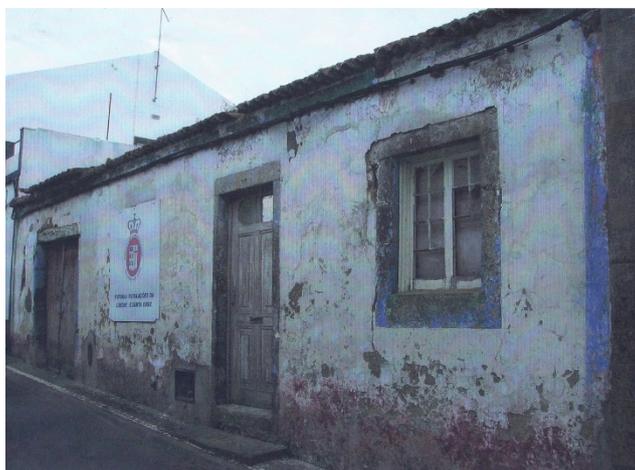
Edifício degradado, adquirido para construção da Creche de Santa Cruz
